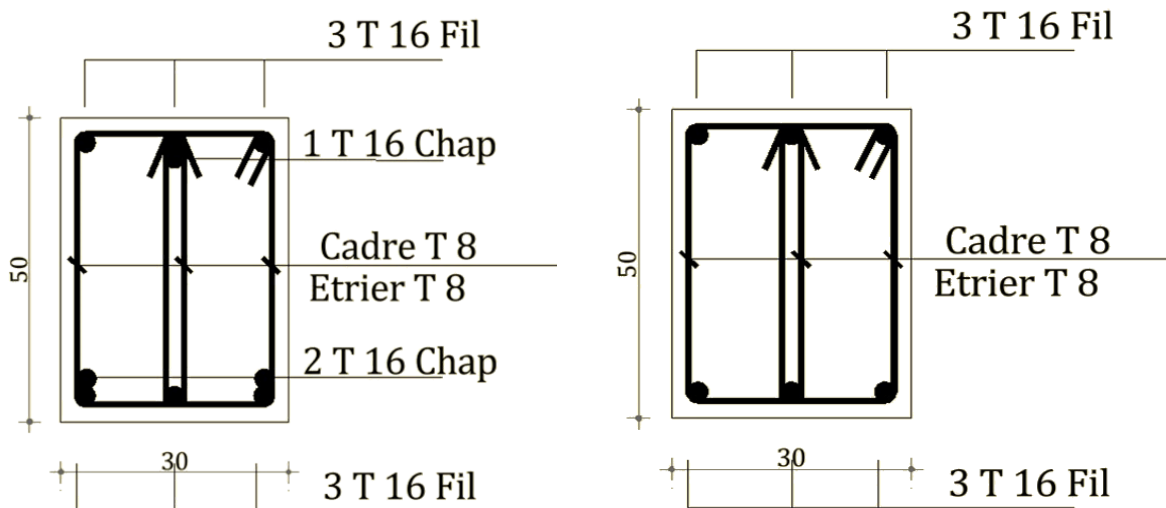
Ferrailage d'une poutre (30 X 50) du Bloc A.
